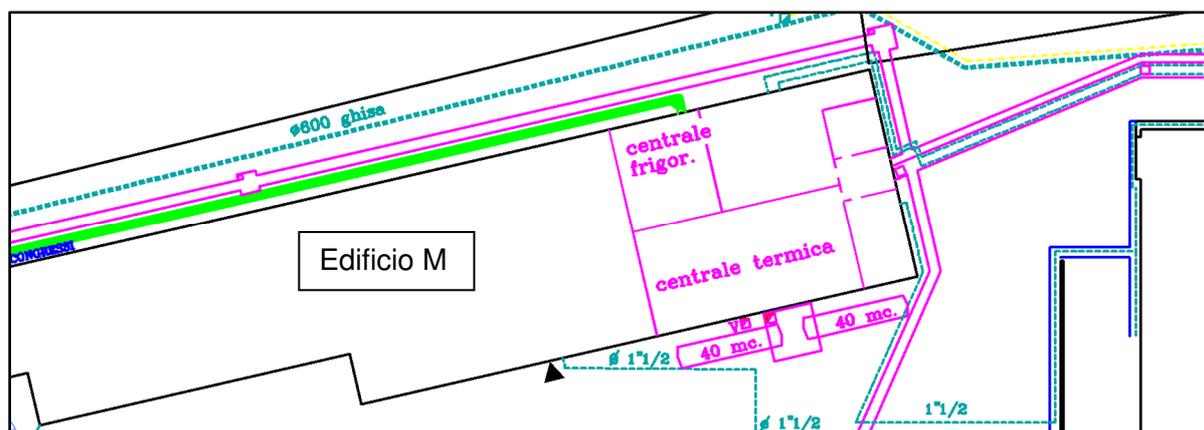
stralcio della planimetria riportante l'ubicazione dei sottoservizi della Fiera di Genova
